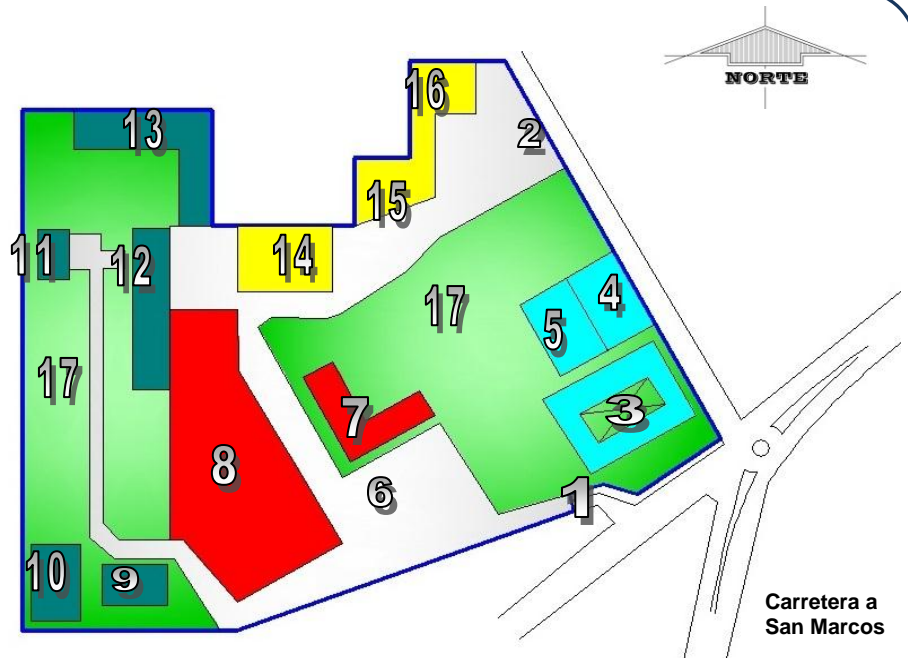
Planta de conjunto INTERVIDA Guatemala
